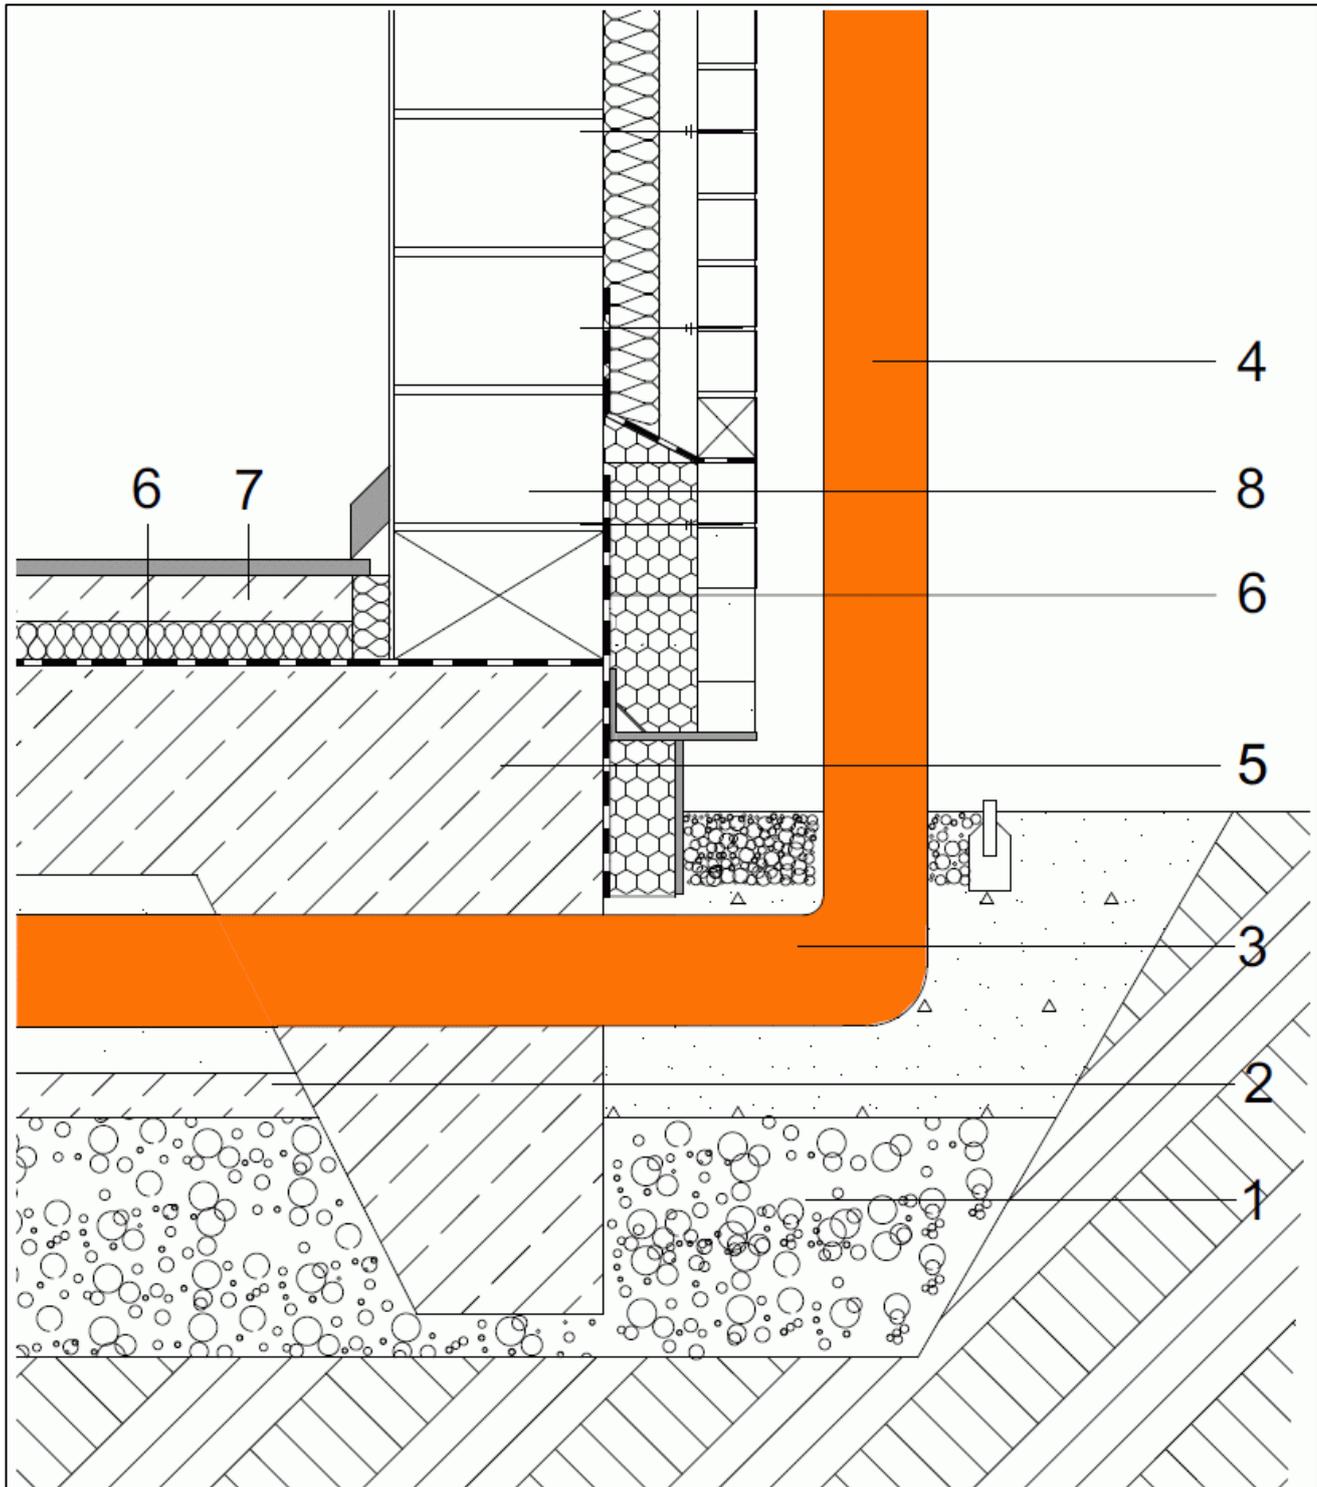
Anschlussdetail Außenwand / Bodenplatte mit Frostschräge und Radondrainage
